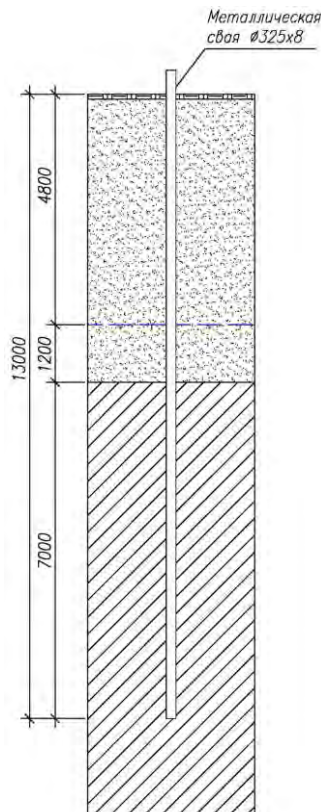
Расположение сваи фундамента длиной 13 м в грунте (для Варианта 3 расчета).
